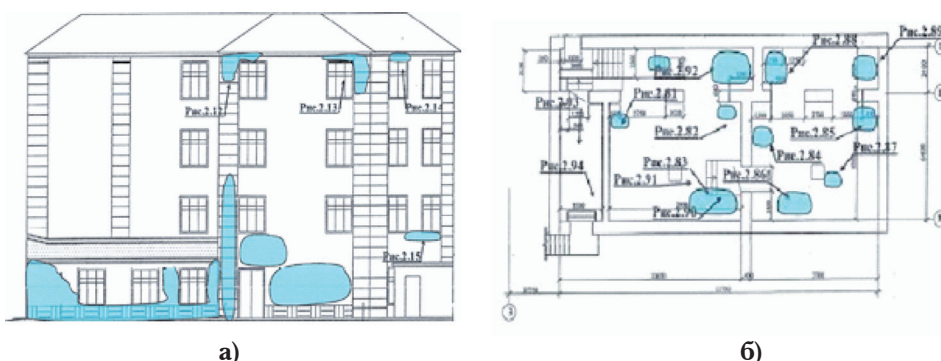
Фрагменти обстеження будівлі, з фіксацією дефектів та пошкоджень: а) – фасад в осях А – Е; б) – план підвалу
